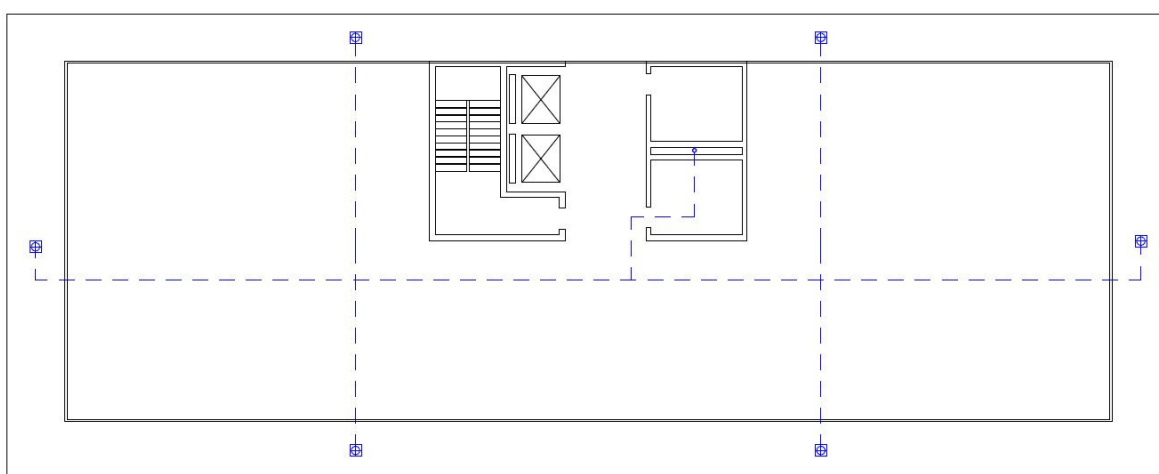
Planta da rede de drenagem de águas pluviais do 7º piso
